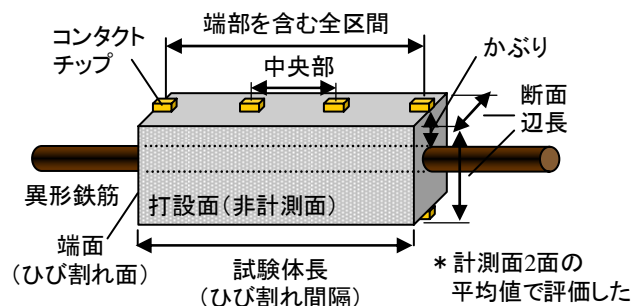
ひび割れ間コンクリート模擬供試体の概略
